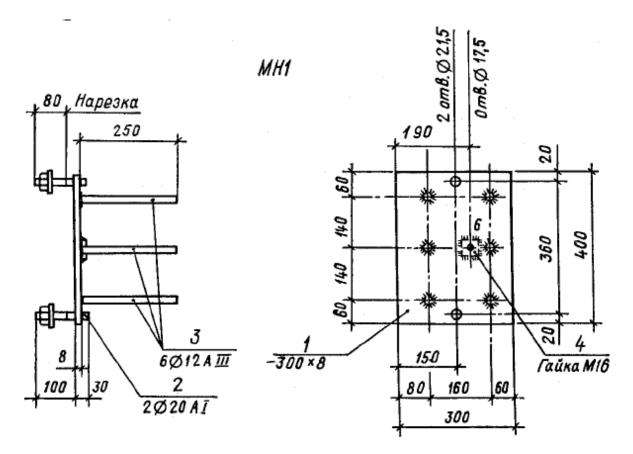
Чертежи закладных деталей колонны ГЛАВА. 5. Чертежи металлических конструкций.
